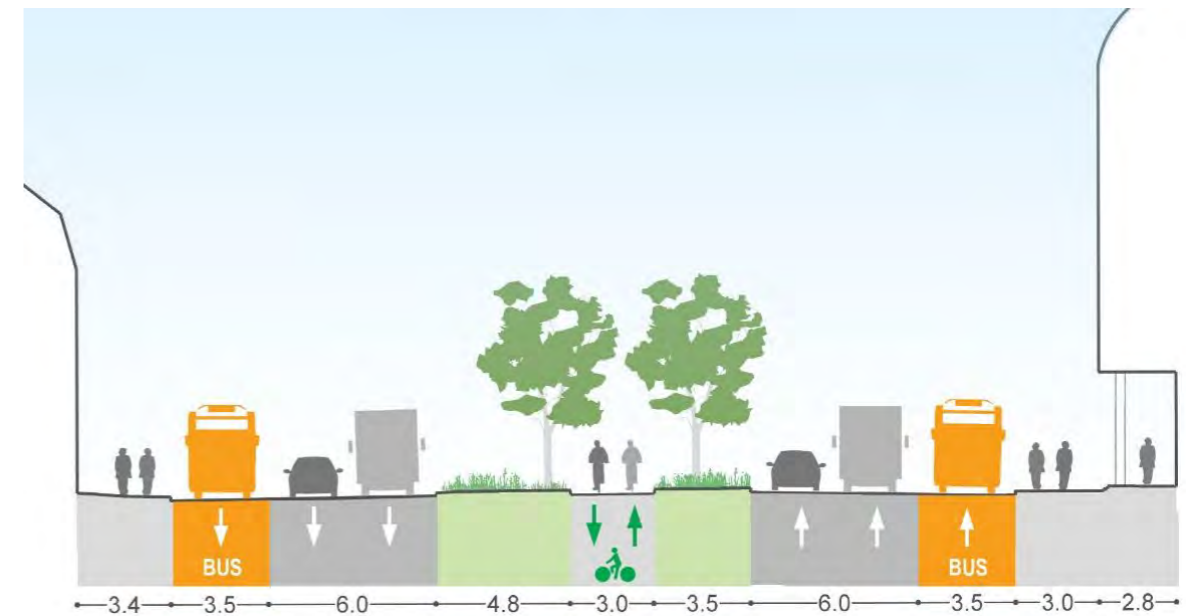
Profil projeté du boulevard Jean Zay (Source : groupement AMO – étude Plan Guide 2023)
